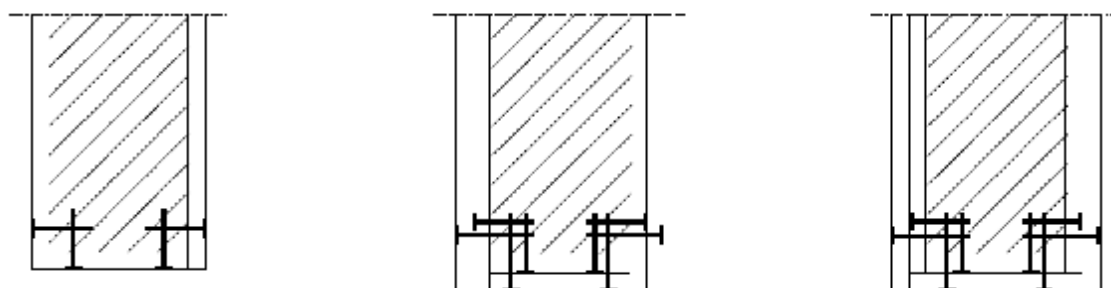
Примеры крепления противопожарных обшивок к балкам или колоннам
